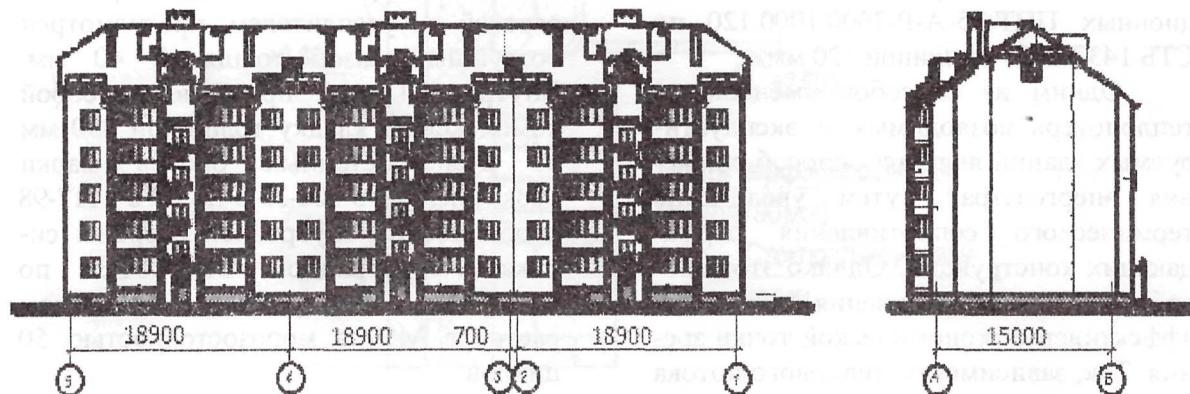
Фасады теплоэнергоэффективного жилого здания
